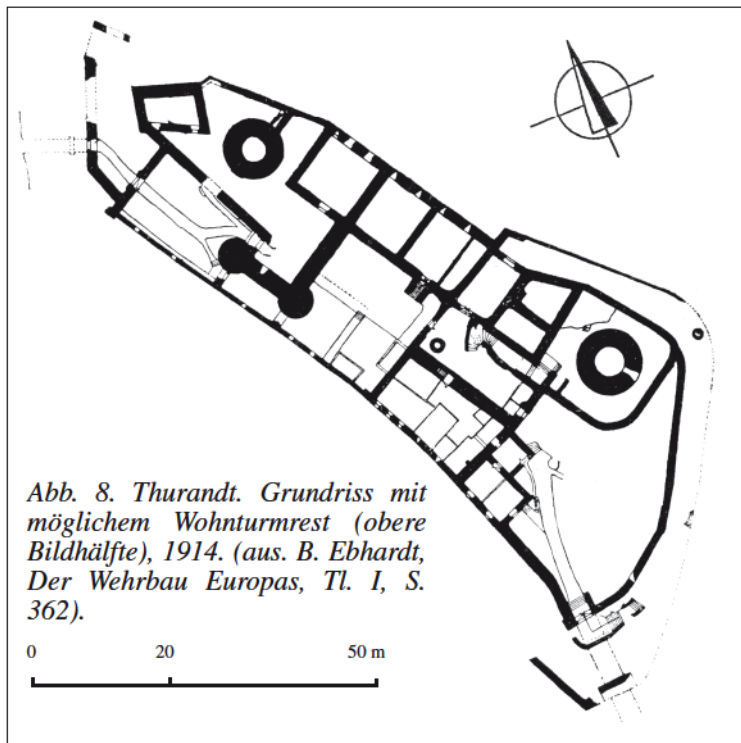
Thurandt. Grundriss mit möglichem Wohnturmrest (obere Bildhälfte), 1914. (aus: B. Ebhardt, *Der Wehrbau Europas*, Tl. I, S. 362).
